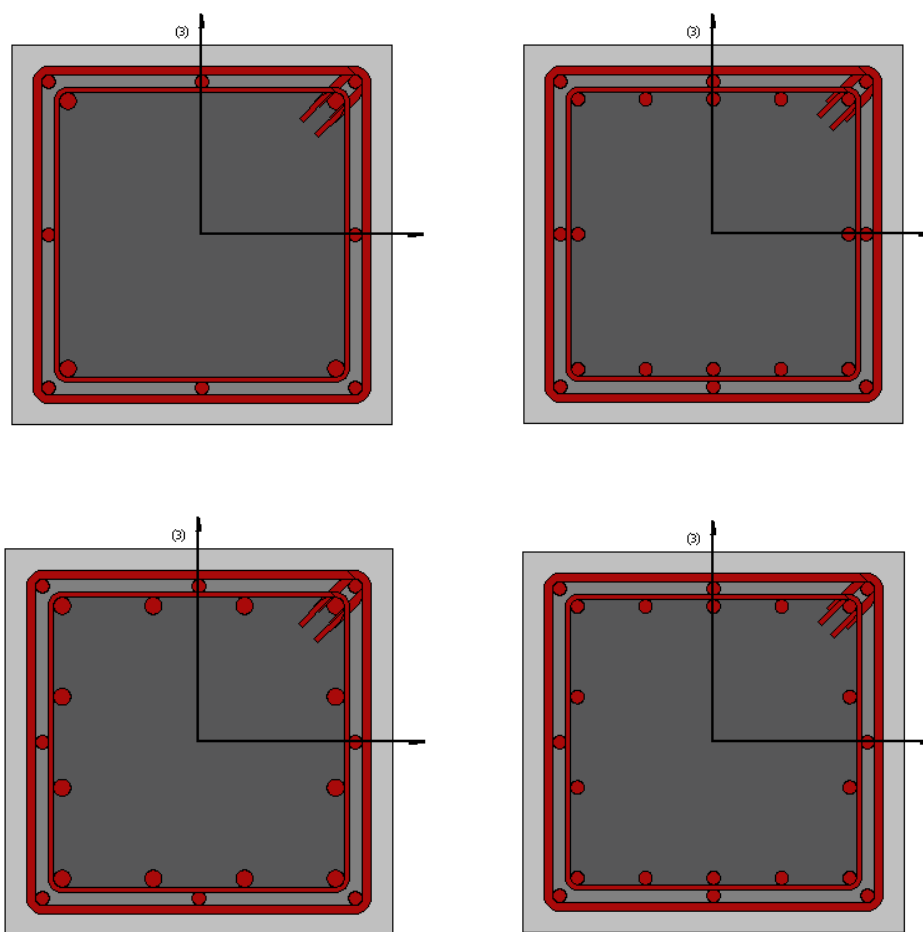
Secções transversais dos pilares com o encamisamento em betão armado.
